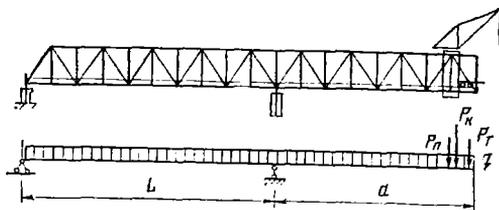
Расчетная схема пролетного строения при навесной сборке
